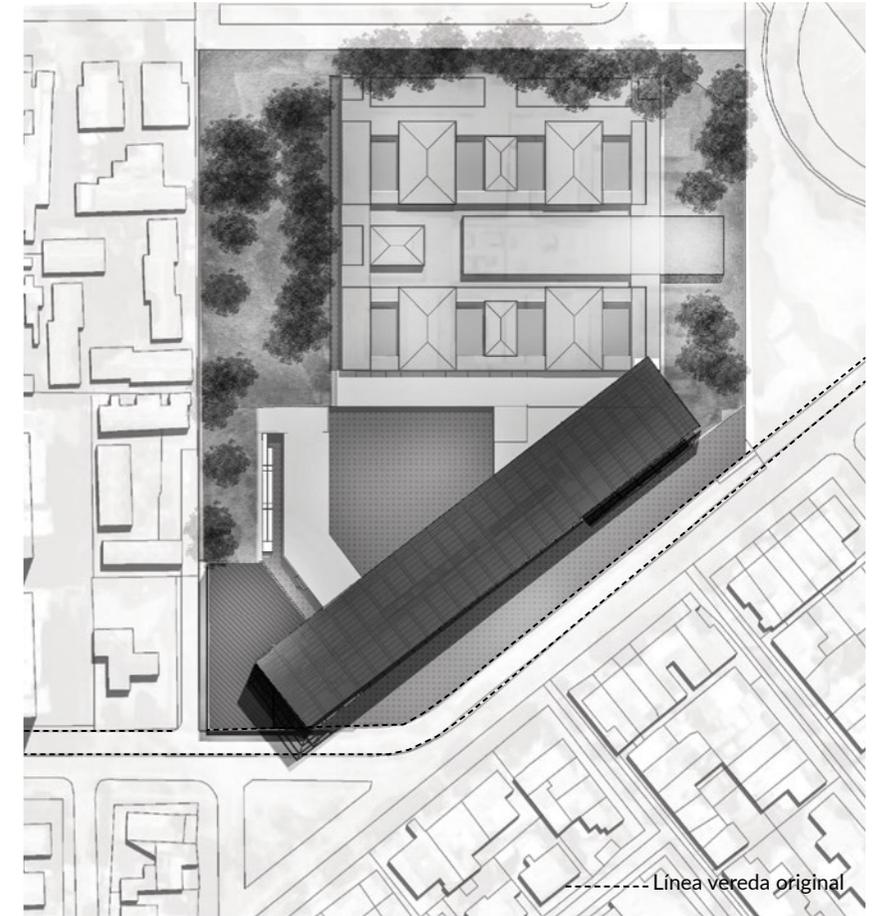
Proyecto en emplazamiento. Fuente: Elaboración propia.
